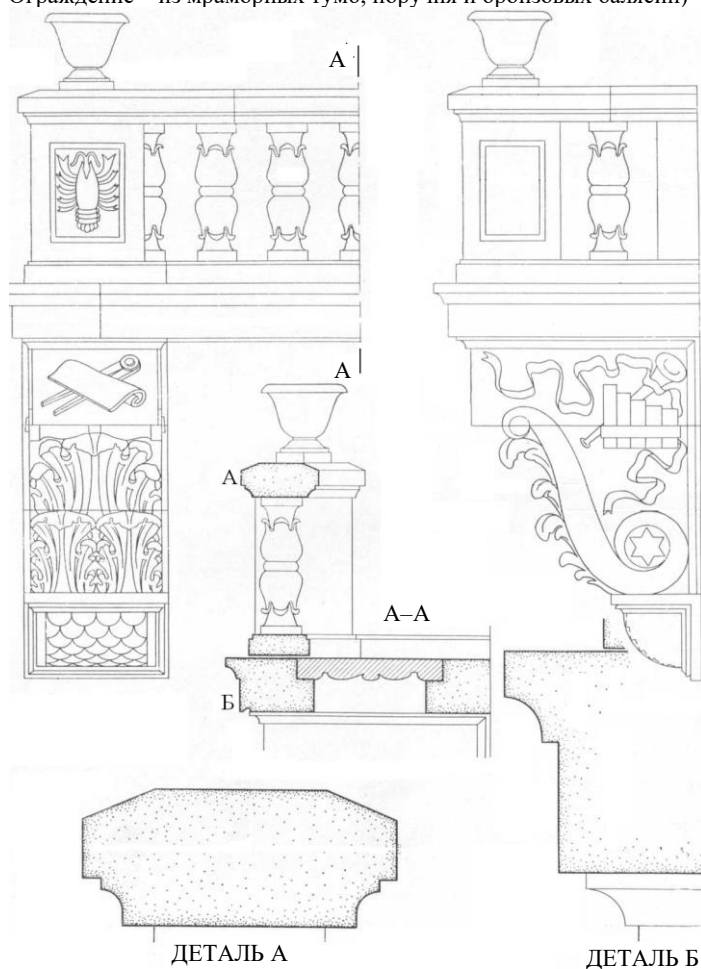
Балкон с развитыми кронштейнами (ограждение – из серого гранита. Кронштейны сложены из четырех рядов камней, заделанных в стены. Плита пола балкона железобетонная)
